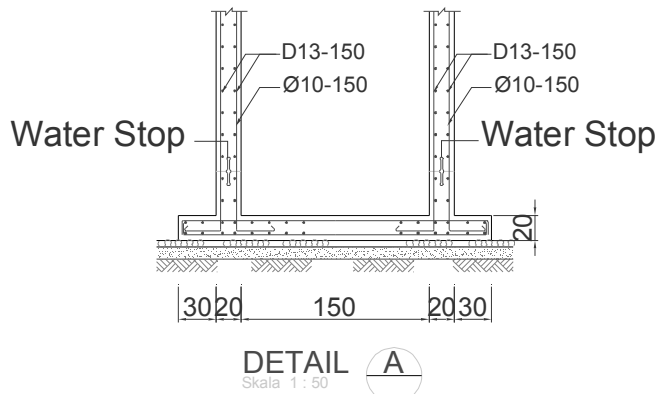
Potongan 4 bangunan pengambilan bendung
